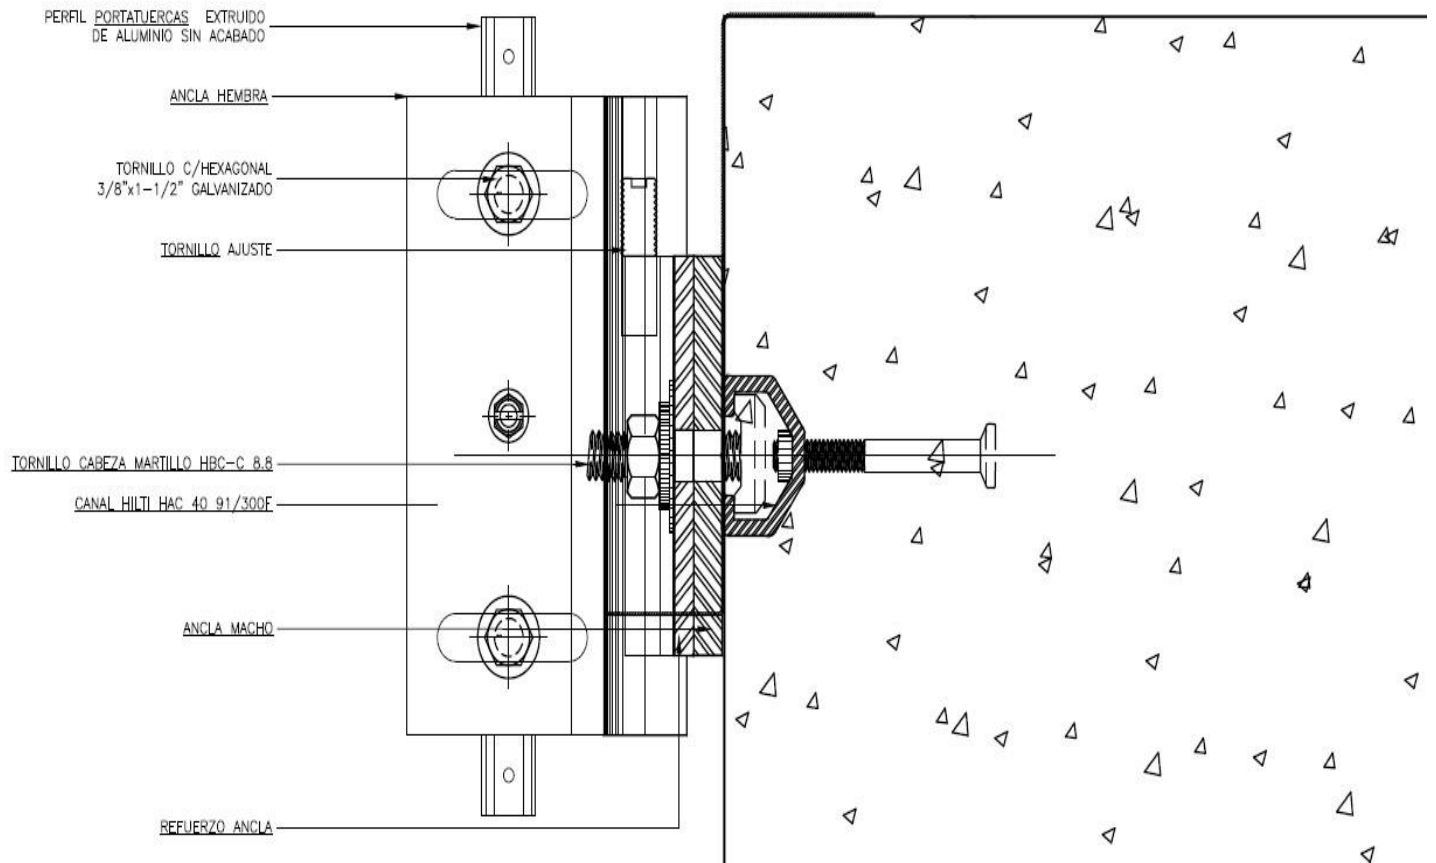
Detalle de sistema de anclaje insertado en losa de concreto.
